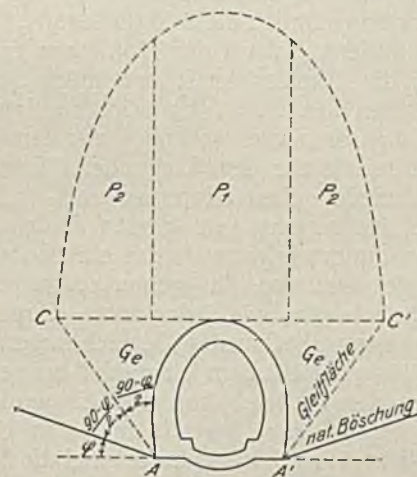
Belastung des Tunnelmauerwerks nach Kommerell.
